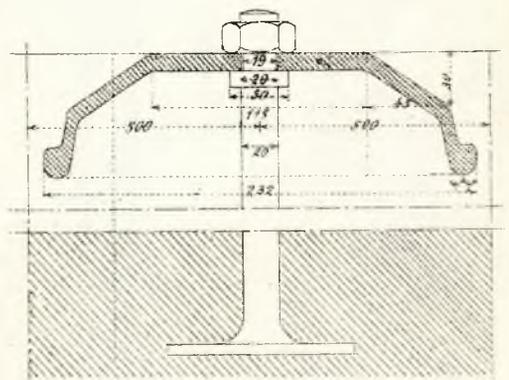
Traversa metallica di giunto con ancoraggio alla muratura.
